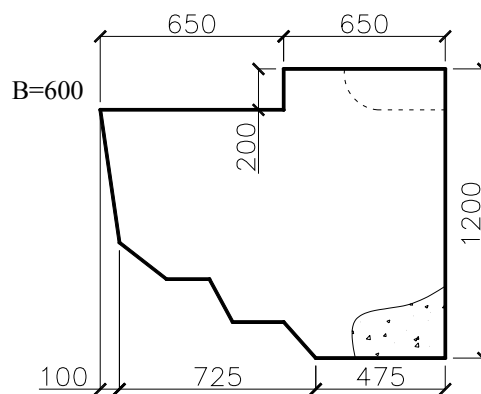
Асиметричний блочний фундамент із втопленим ядром /ЦНИИЭПсельстрой/
